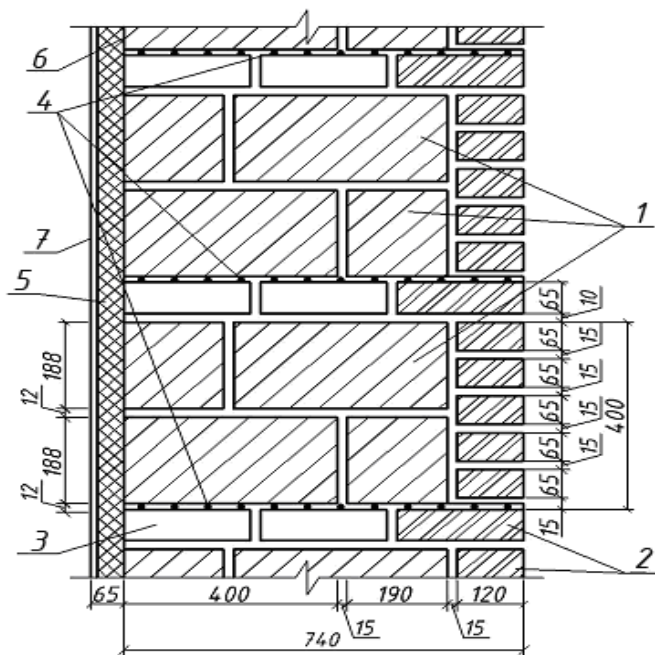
Конструкція зовнішньої стіни з внутрішнім утеплювачем: 1 – керамзитобетонні блоки; 2 – лицьова цегла; 3 – рядова керамічна цегла; 4 – арматурні сітки; 5 – утеплювач; 6 – пароізоляція; 7 – внутрішнє оздоблення
